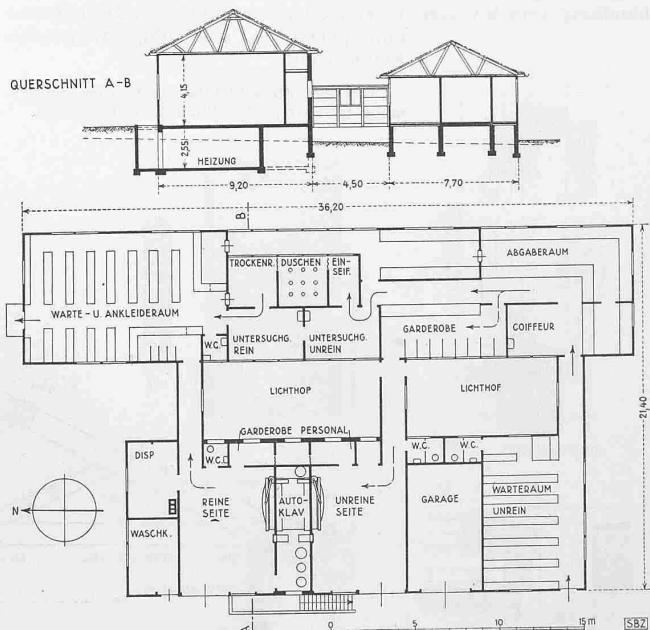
Grenz-Notspital Schaffhausen Grundriss 1:400 der Desinfektionsanlage
